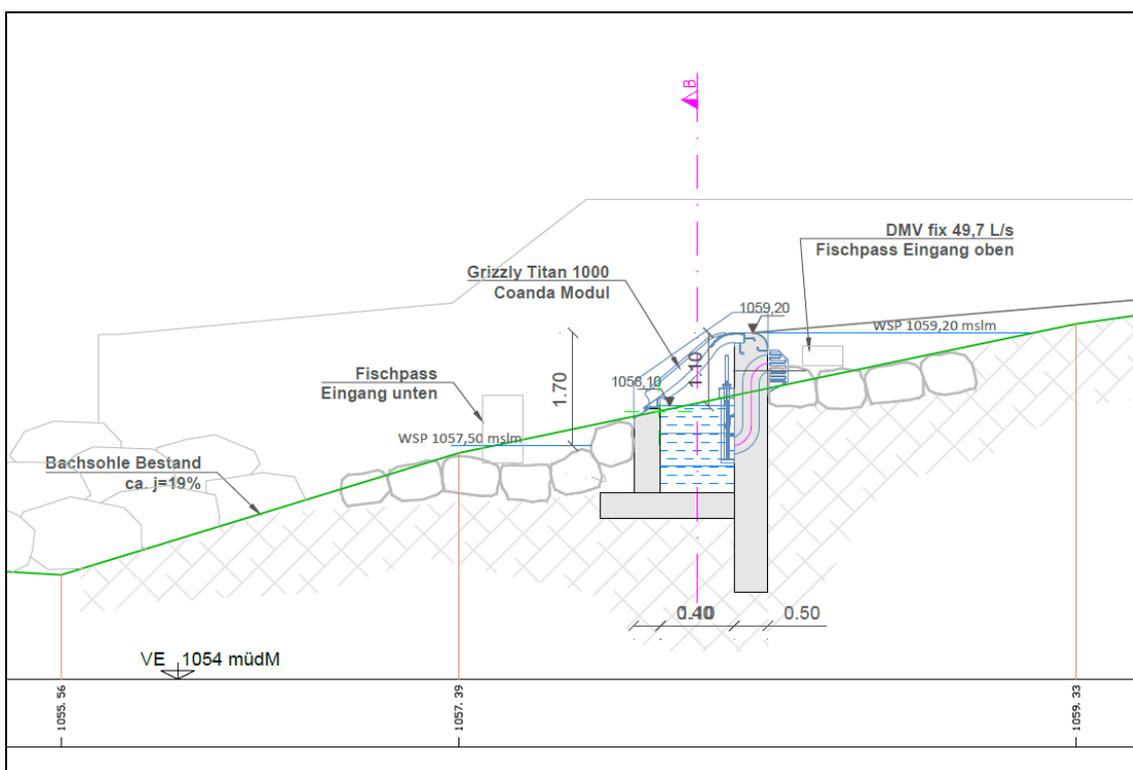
Sezione dell’opera di presa di progetto (fonte: Tavole progettuali)
